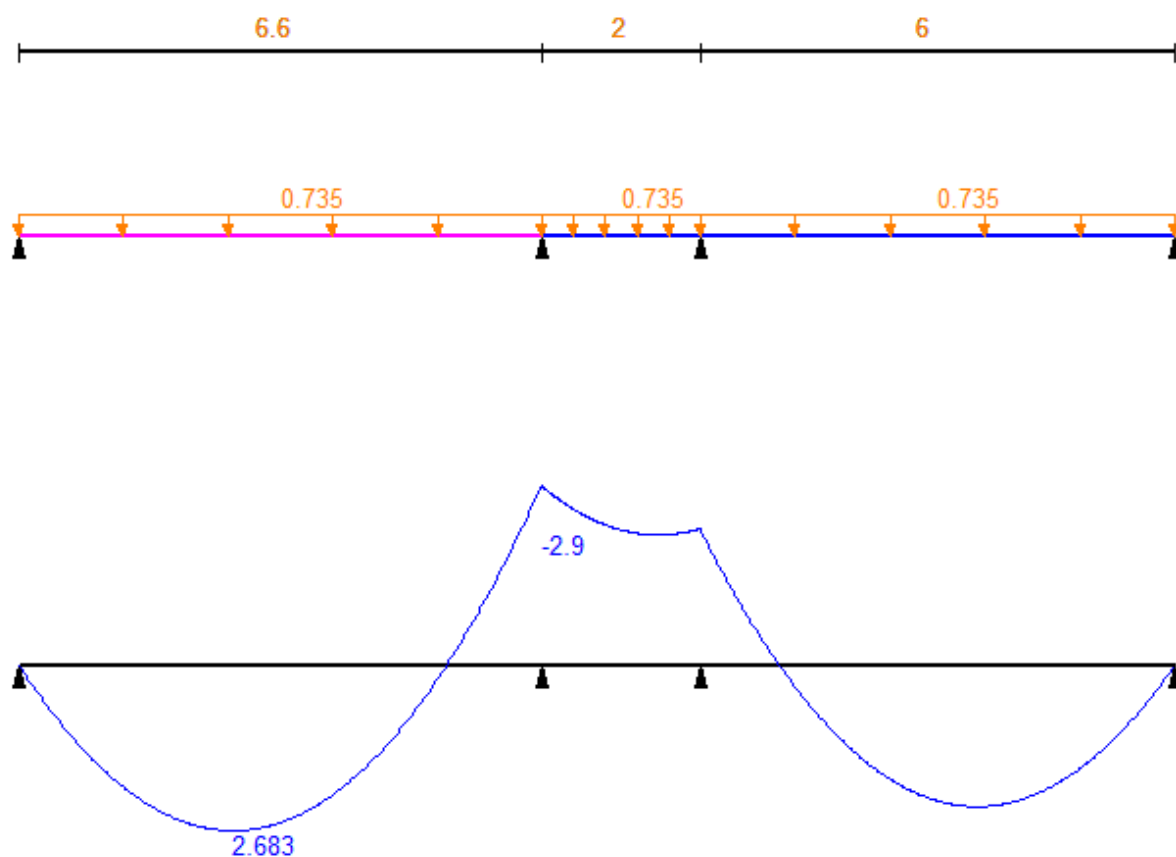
К расчету плиты перекрытия на стадии эксплуатации
